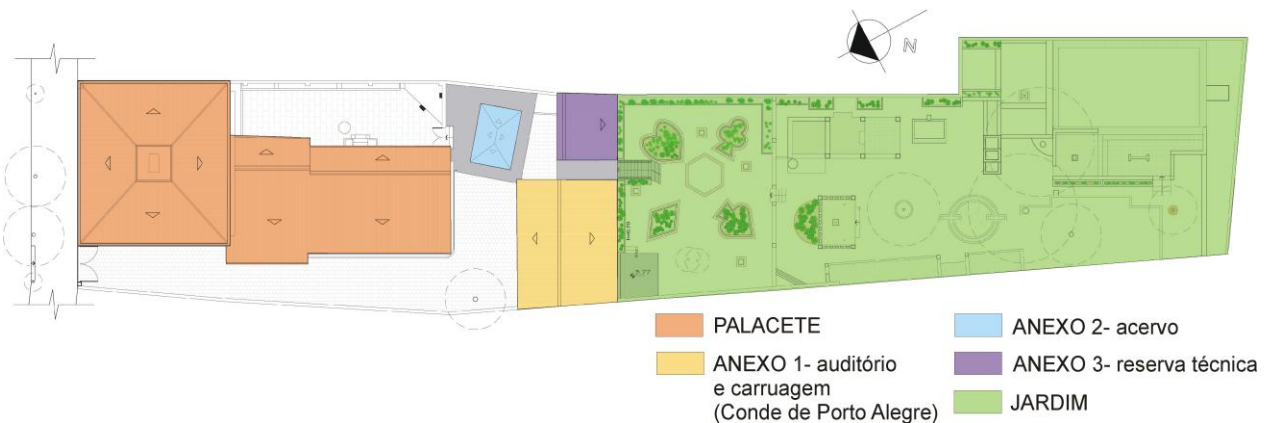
Planta de localização das edificações componentes do sítio em estudo.
